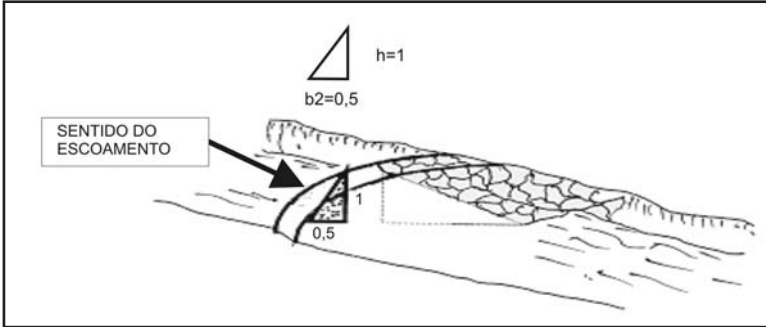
Estrutura e Dimensões do Talude à Montante de uma Barragem
